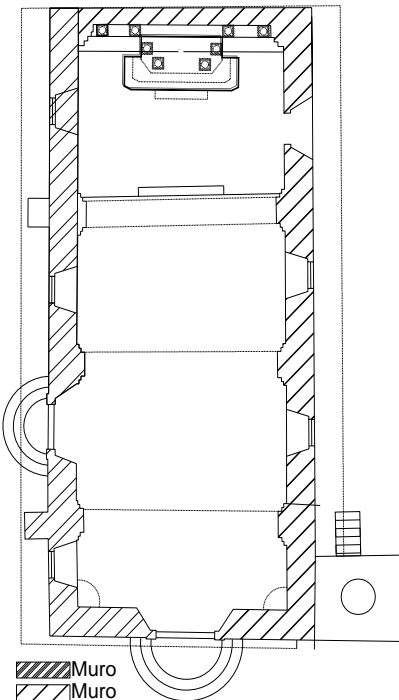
Muro de mampostería aparejada de la capilla de la Santísima Trinidad Fotografía y dibujo Autor JOBG, Año. 2017
